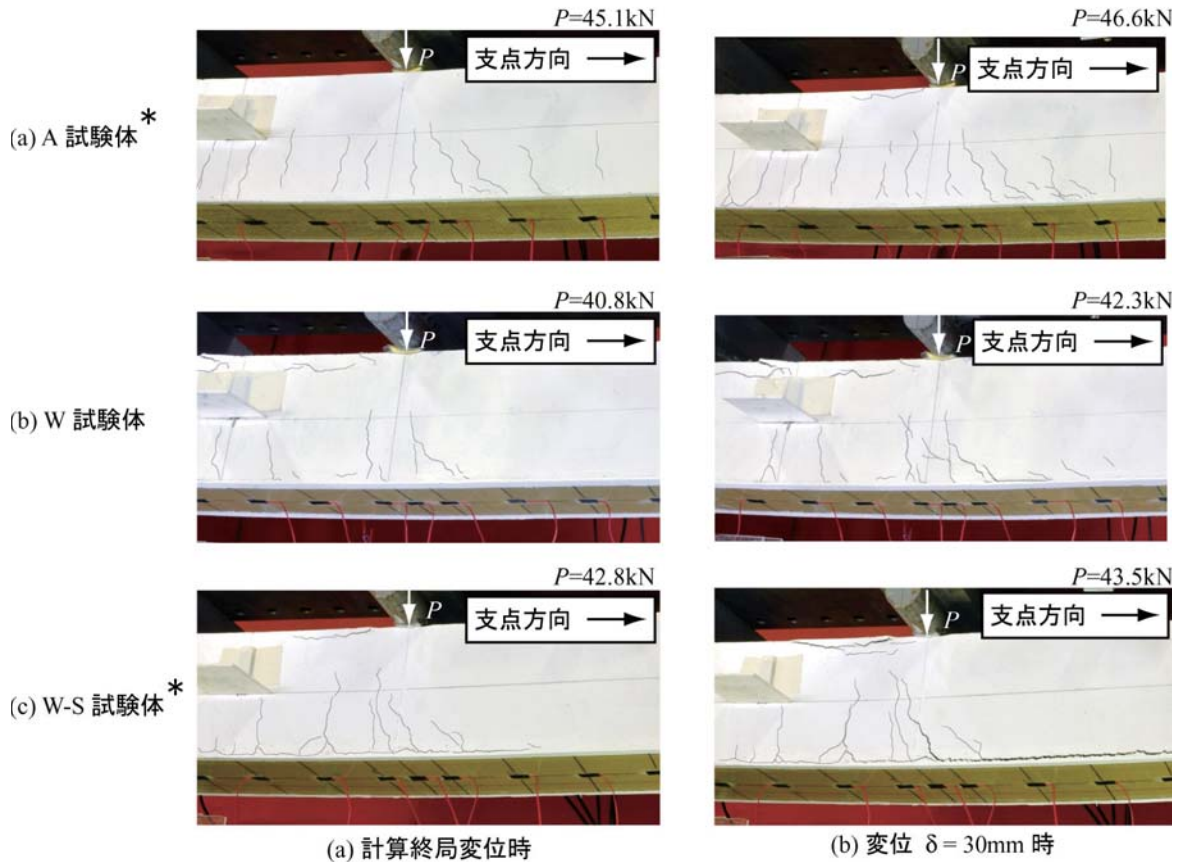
各試験体の剥離直前におけるひび割れおよび剥離性状
